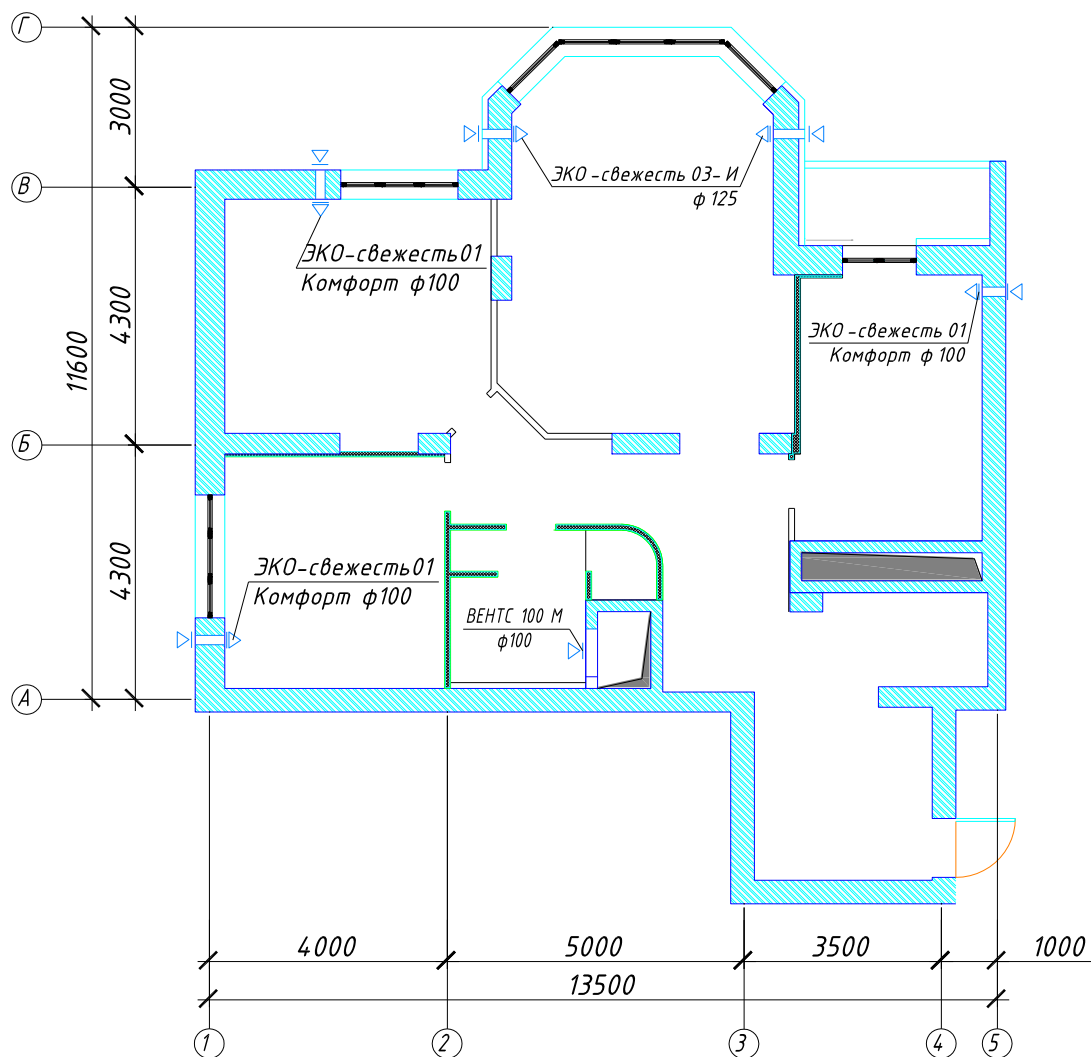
Размещение вентиляционного оборудования по Варианту № 2 на плане жилой трёхкомнатной квартиры
